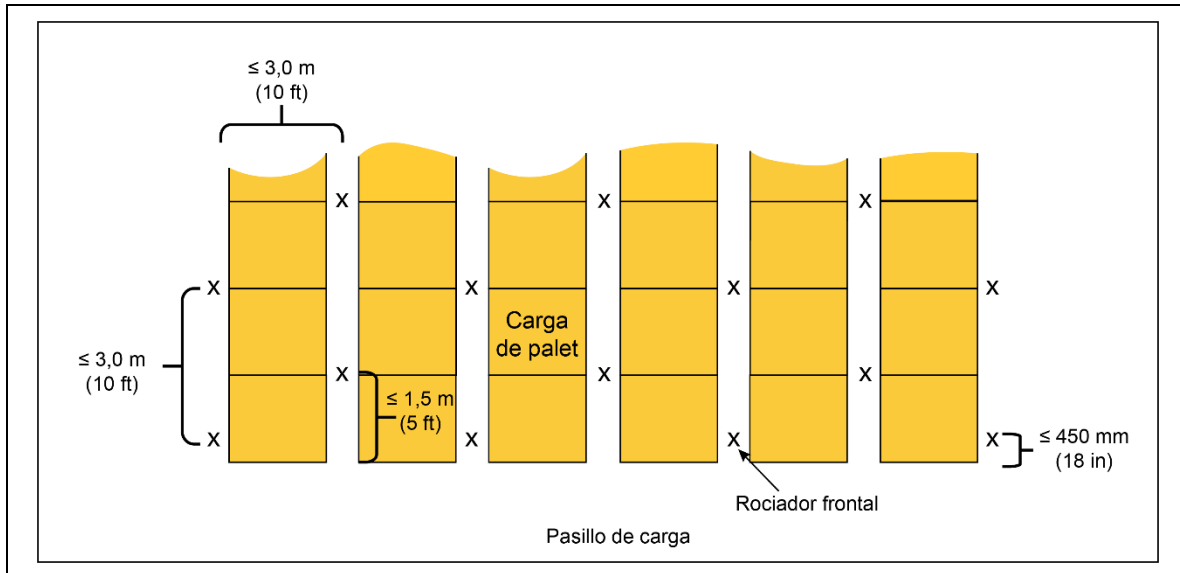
Vista en planta de una configuración horizontal de rociadores intermedios cada dos chimeneas transversales para estanterías múltiples
